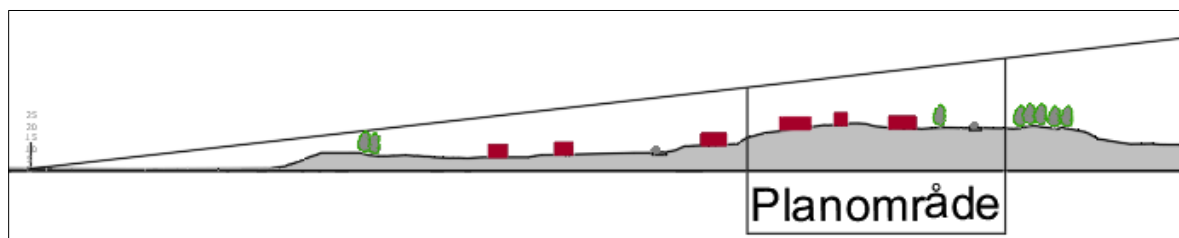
Figuren viser snitt av planområdet med tenkt utbygging jf. skissen. Hyttene i snittet skaper ikke silhuett, forutsatt at noe vegetasjon beholdes på den høyeste kollen i planområdet. Kollen ligger som grønnstruktur i planen.
